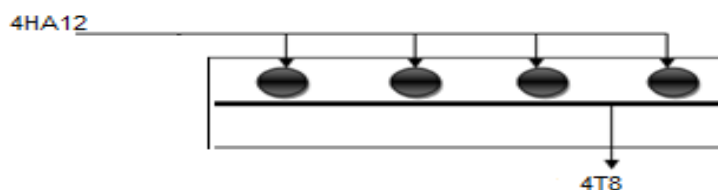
Schéma de ferrailage de la dalle pleine (D4)
